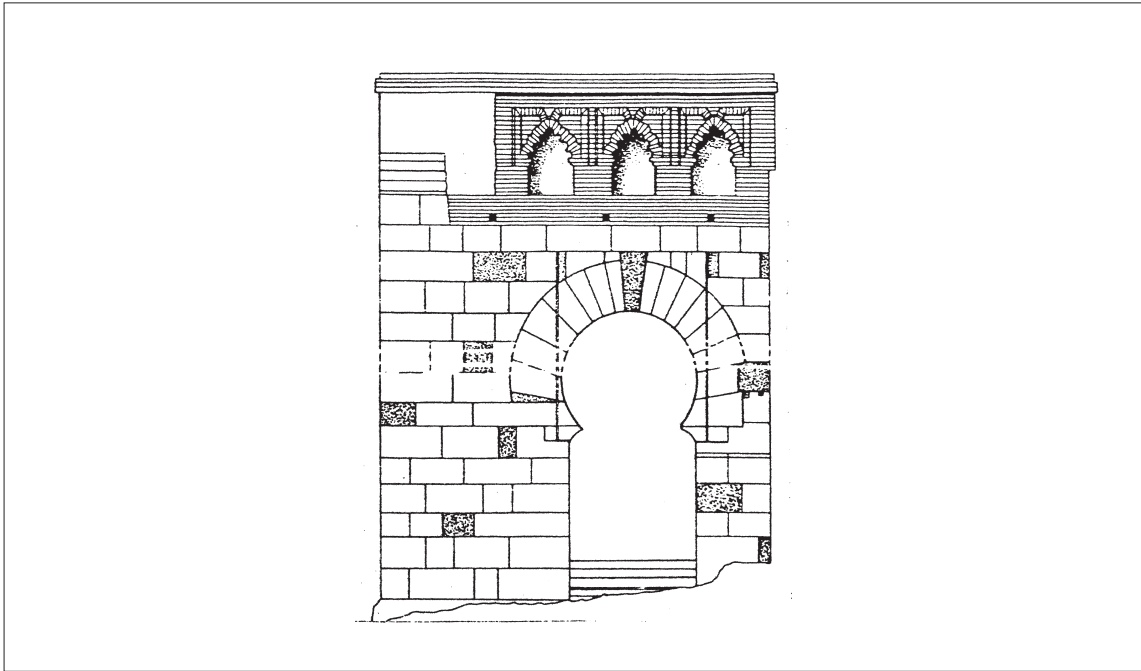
ليلة. باب المرفأ، مسقط أفقى. عن (Maldonado).
